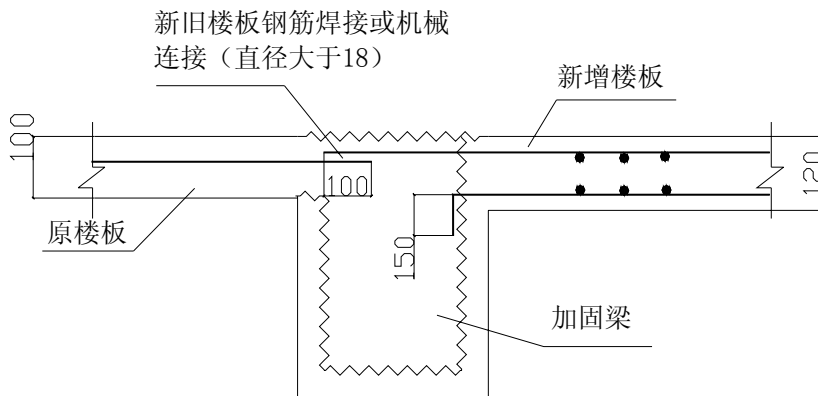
新、旧混凝土顶板及加固梁连接示意图
